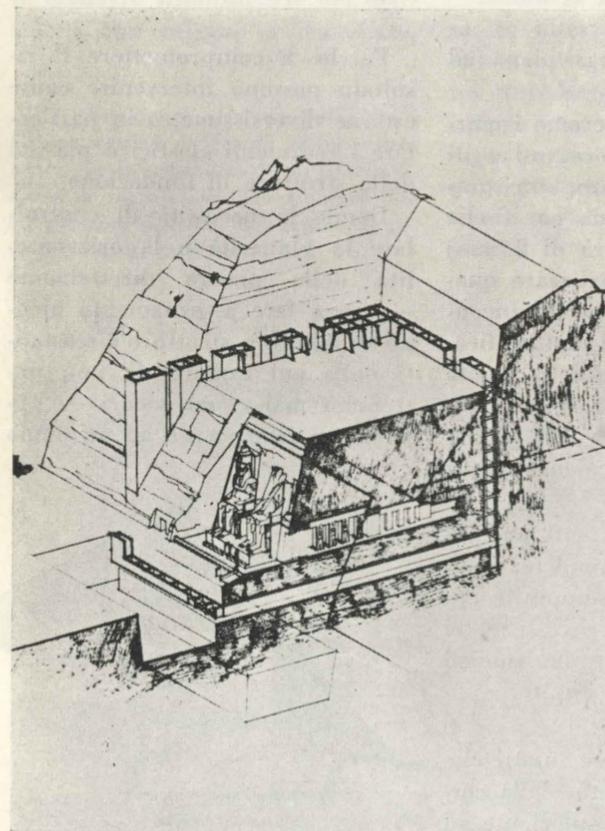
Vista assonometrica del blocco che contiene il tempio (durante la costruzione delle strutture in cemento armato).
